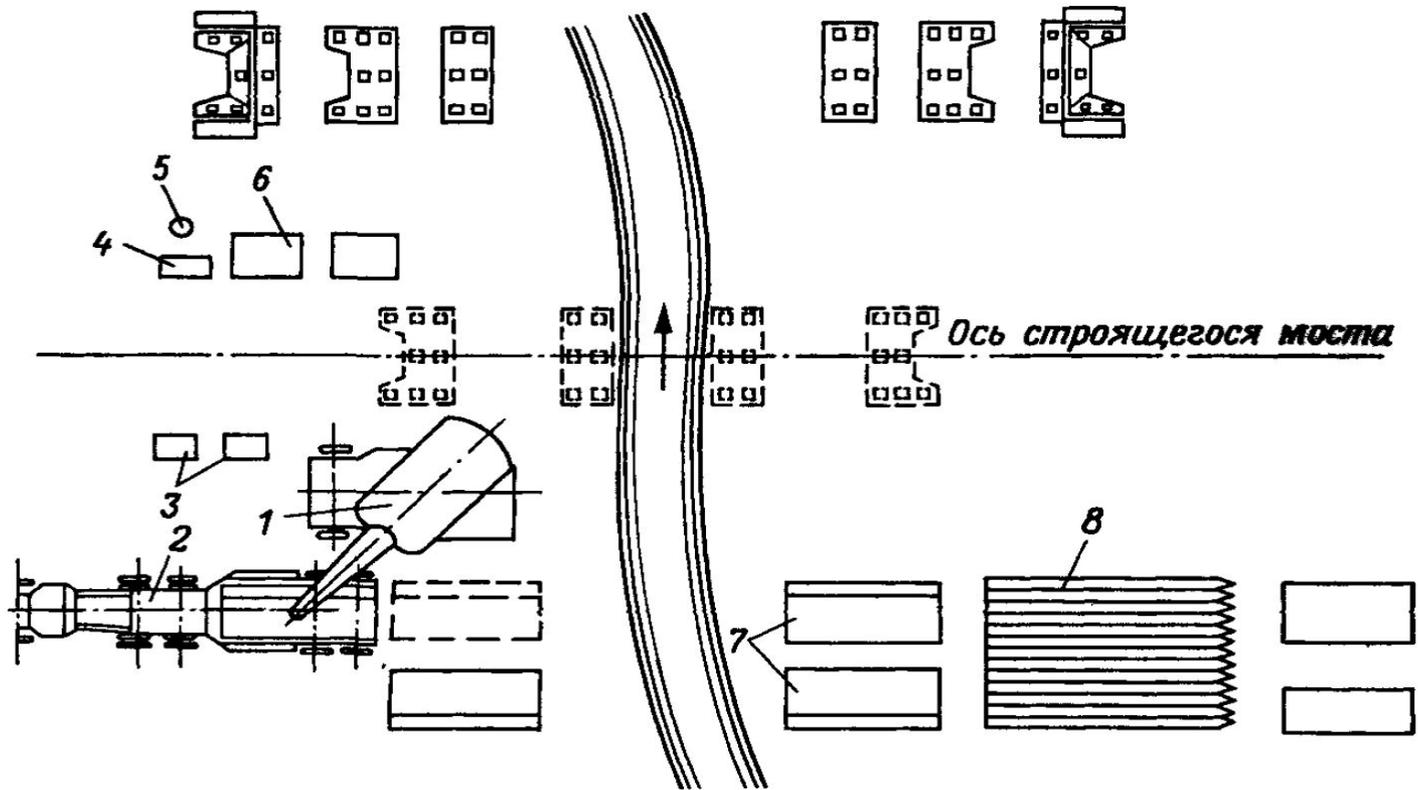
План строительной площадки трехпролетного свайного моста длиной 22 м:
